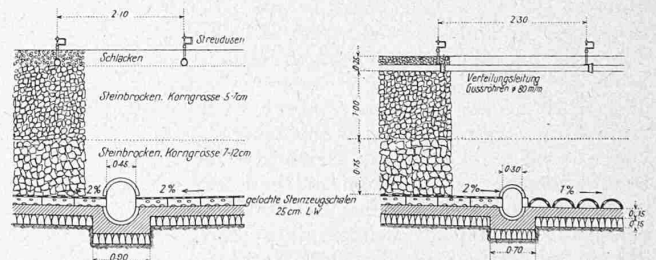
Aufbau-Detail der Tropfkörper. — Masstab 1:100.
